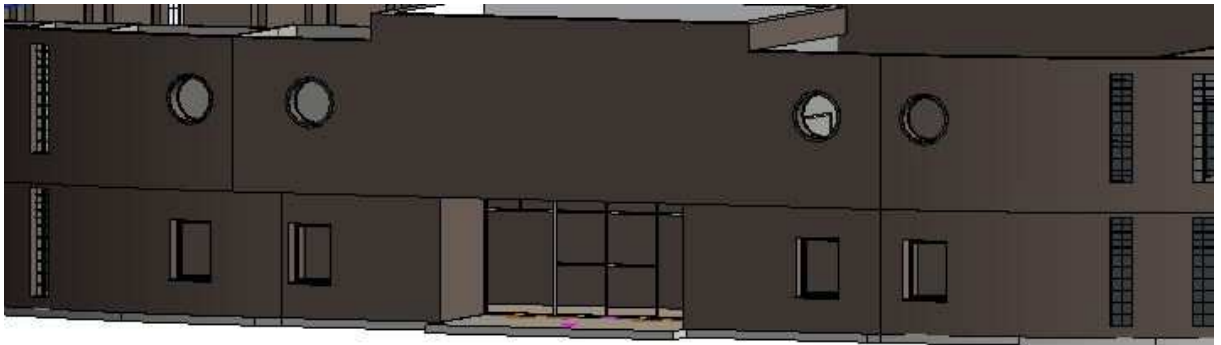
Entrada a la planta inferior del pabellón en Revit.
